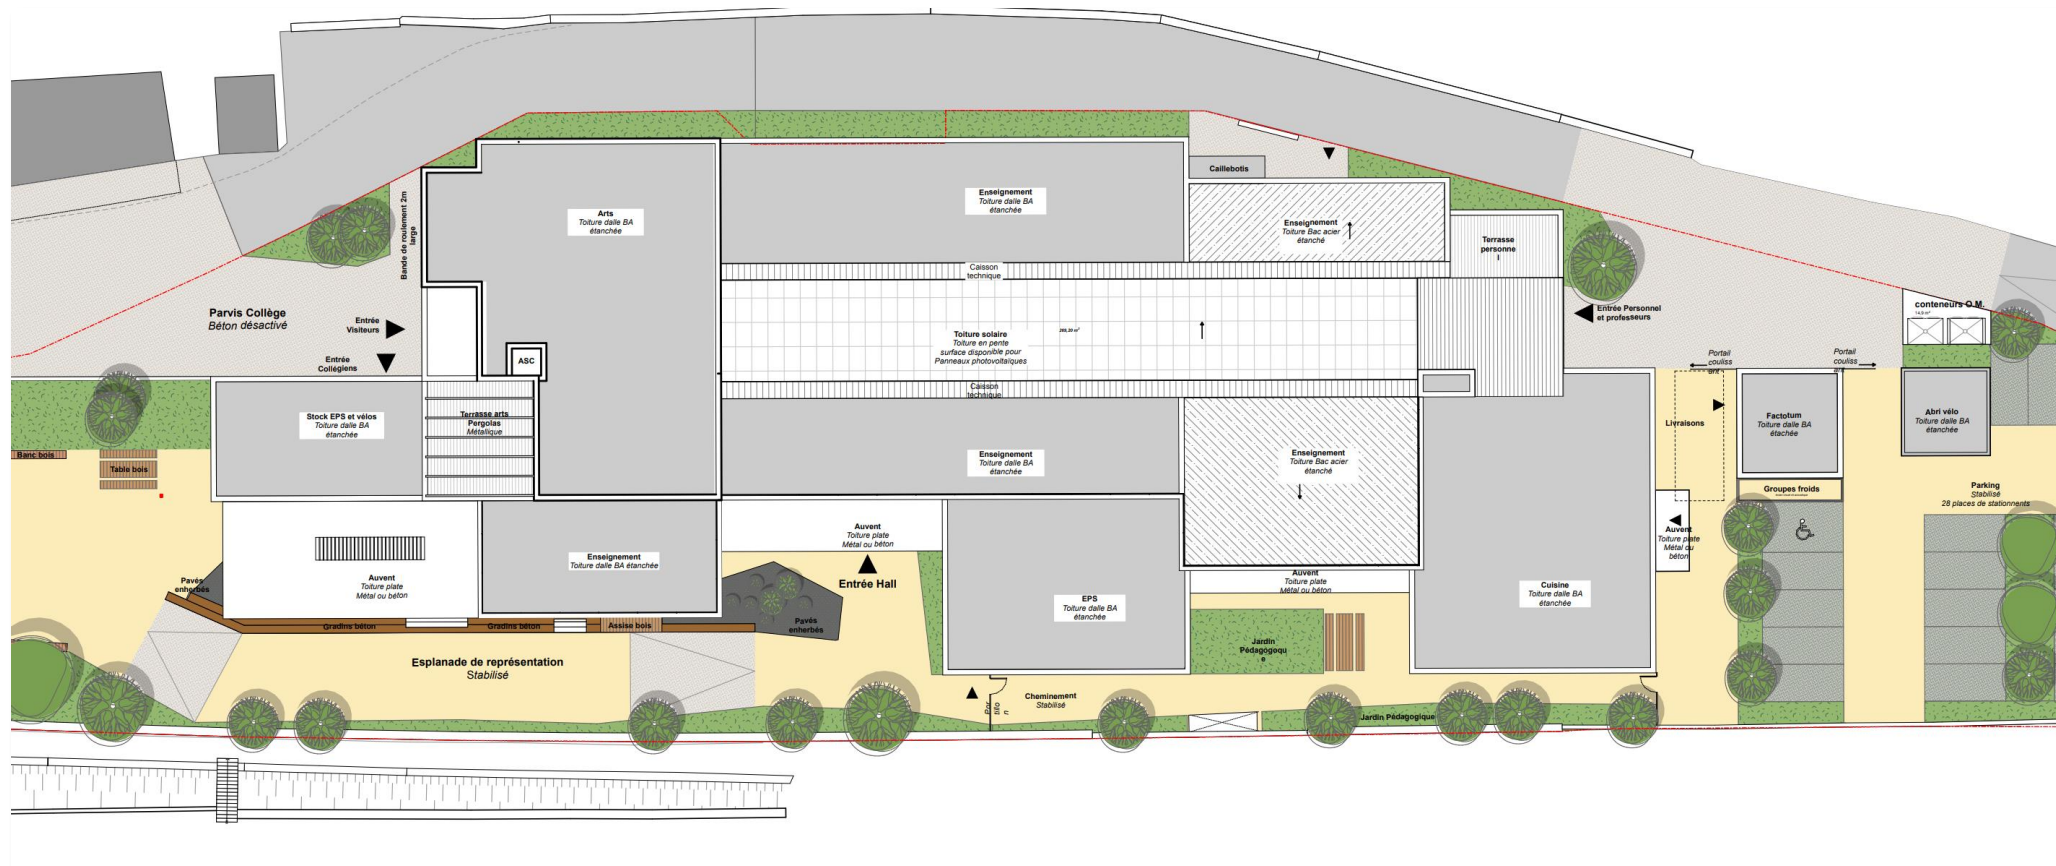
EXTRAIT DU PLAN MASSE DU PROJET DE RESTRUCTURATION
